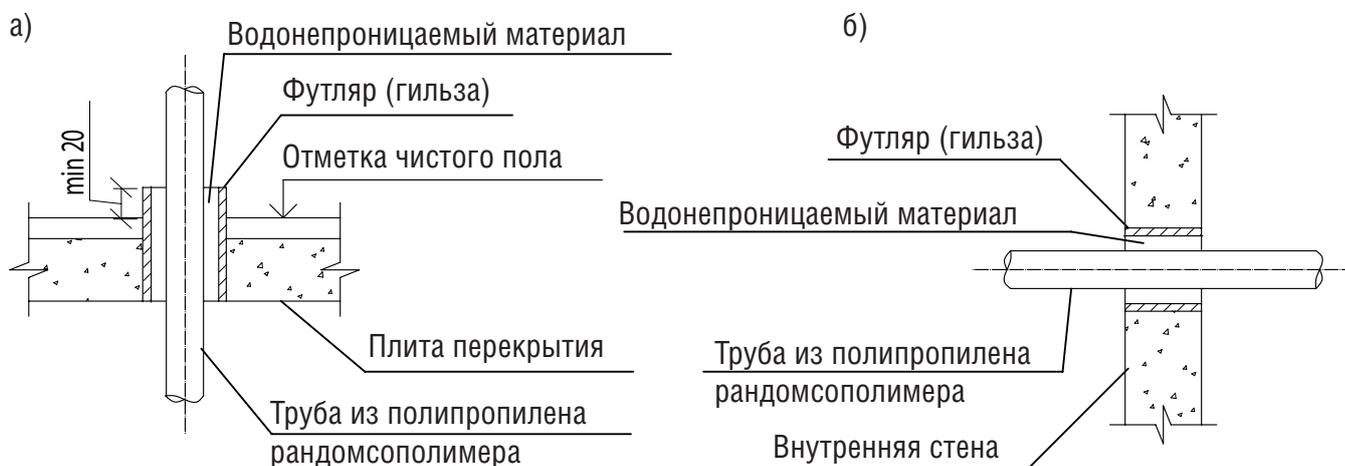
Установка футляров для прохода напорных труб из полипропилена рандомсополимера через строительные конструкции.
